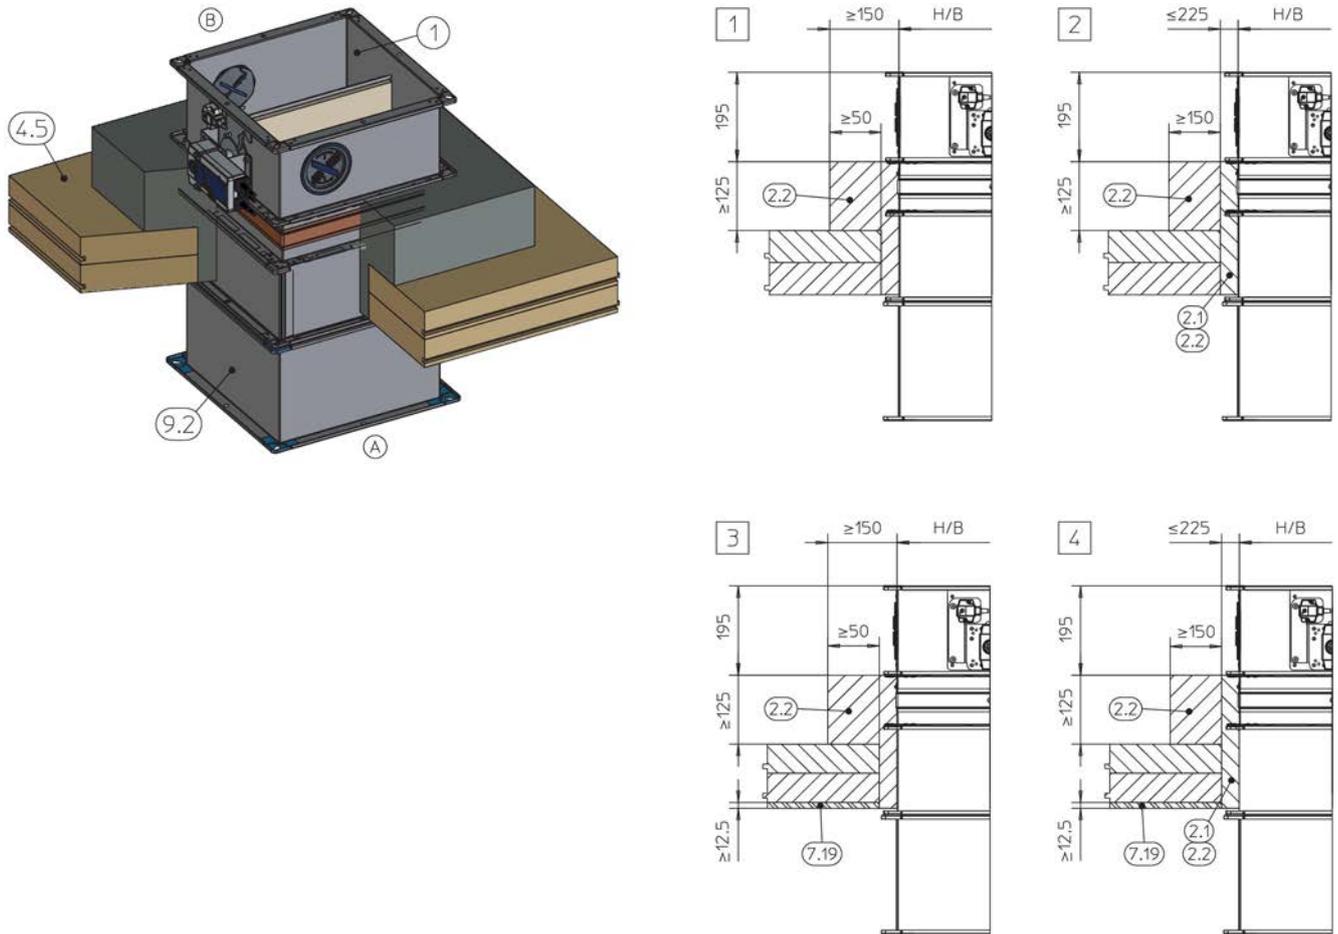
Instalación vertical con mortero en forjado en combinación con vigas de madera / techos de madera laminada, (se muestra un ejemplo, para otros diseños de techo con vigas de madera)
